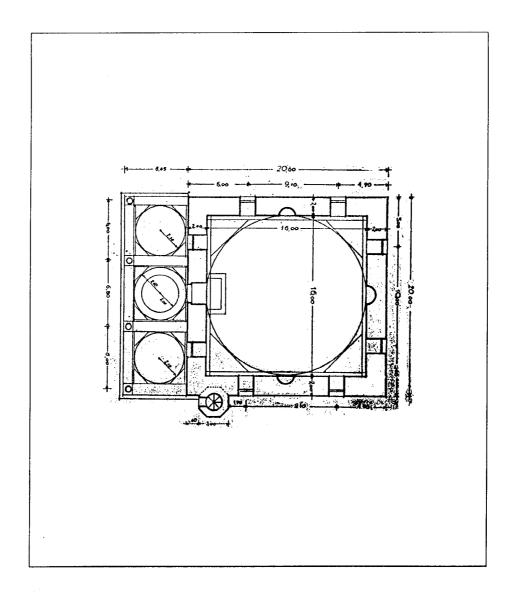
مسقط أفقي لمسجد محمد بك في سيريز (عن : كيل) .
